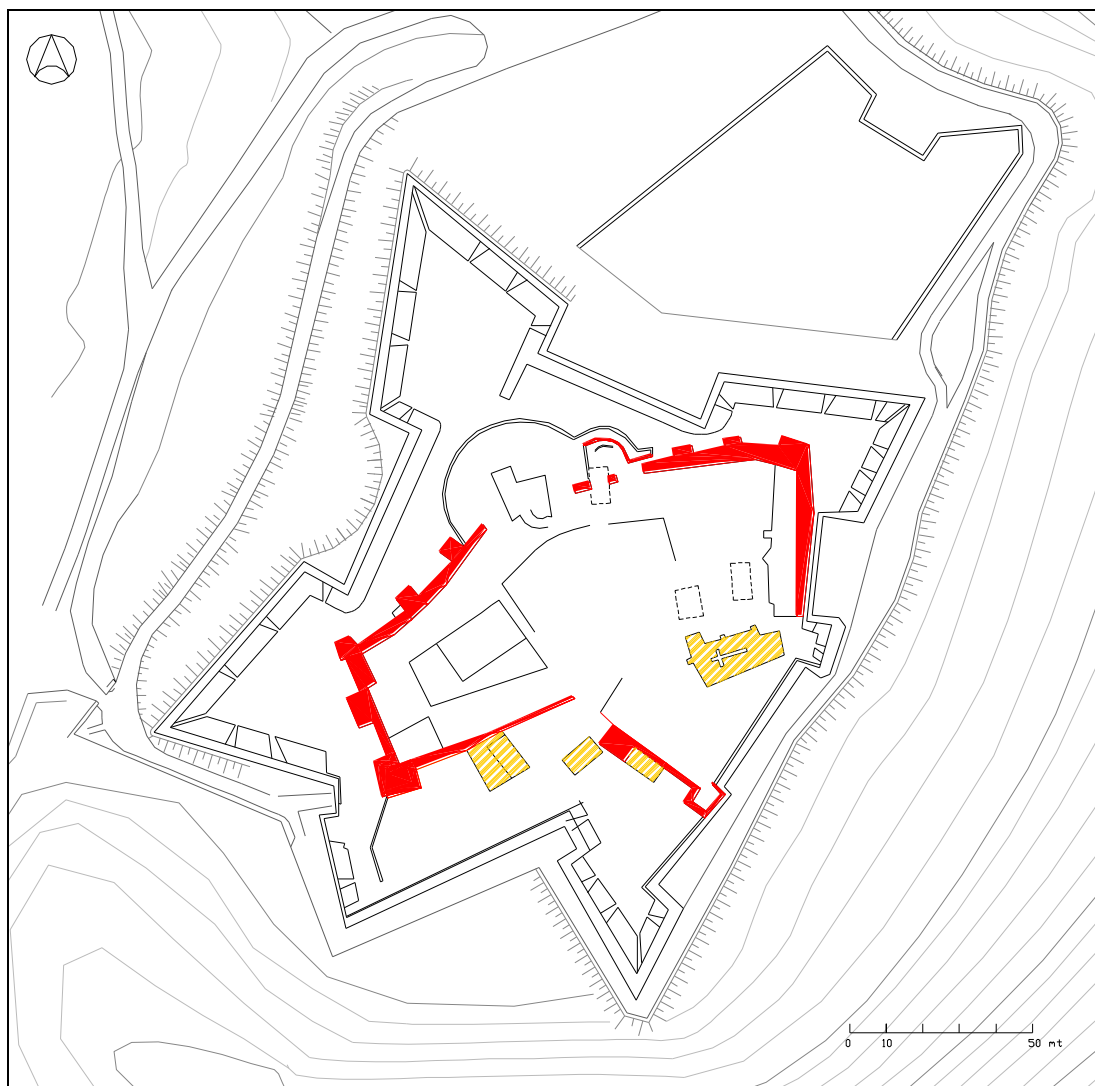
Planta do monumento, com destaque para o perímetro medieval, assinalado a vermelho.
